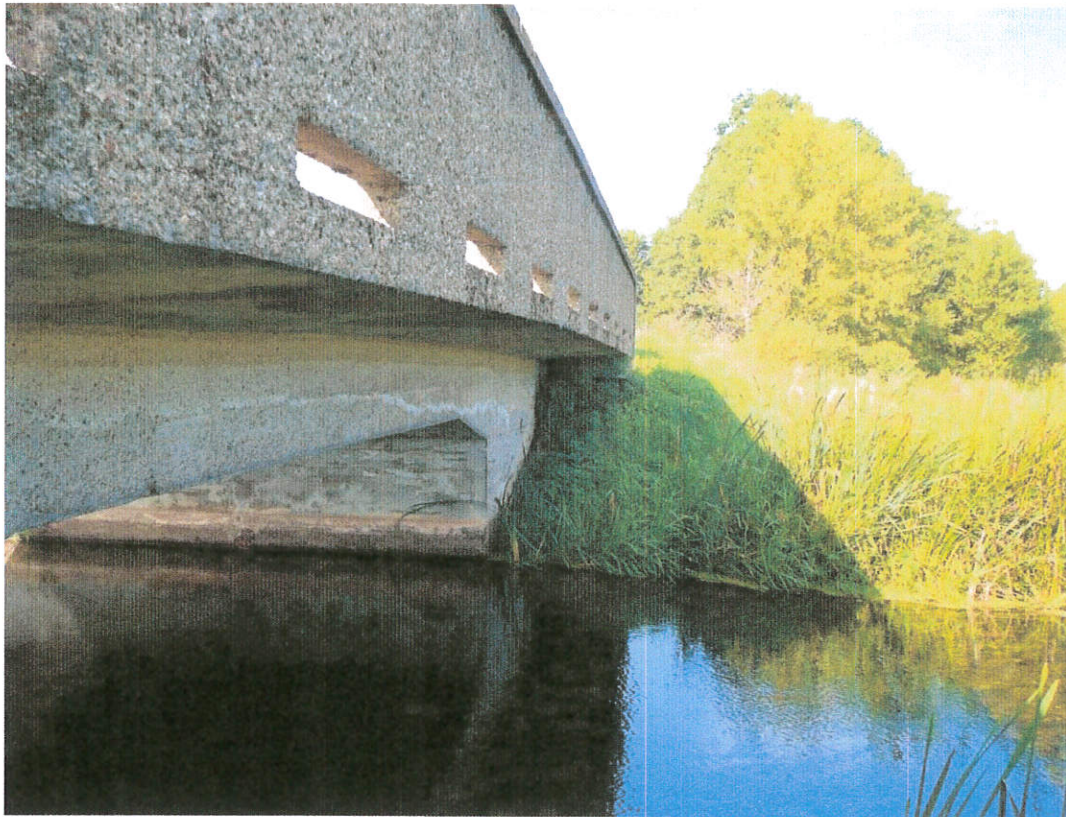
Widok balustrady. Ubytki betonu. Korozja zbrojenia.
